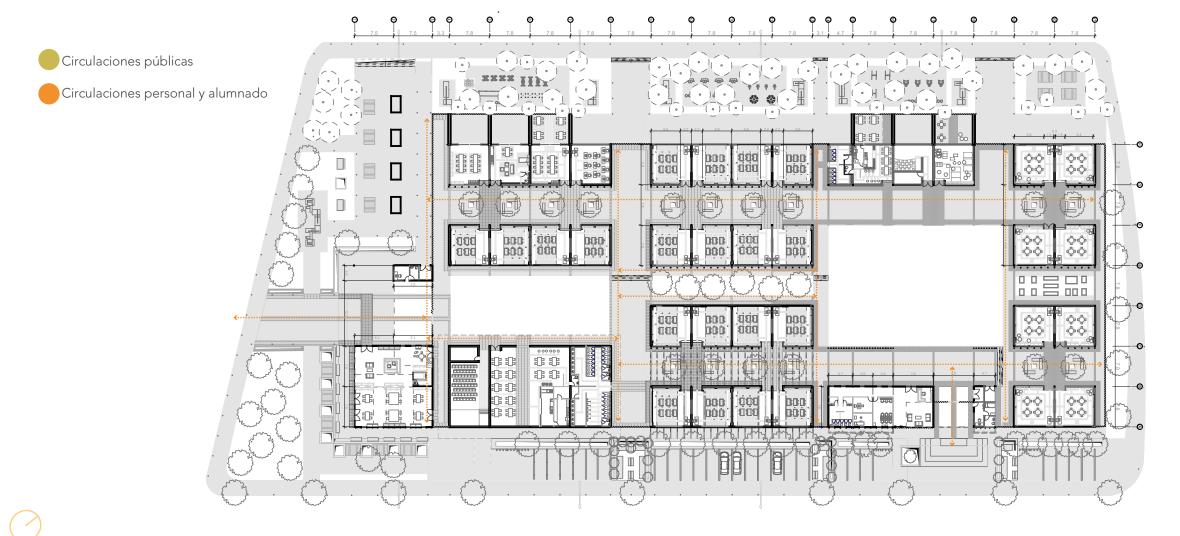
planta general circulación Fuente: Elaboración propia 2023.
